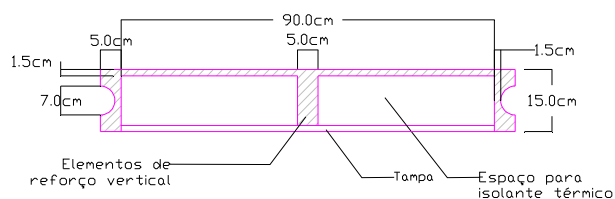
Corte transversal de um painel típico da primeira alternativa para o sistema construtivo.
